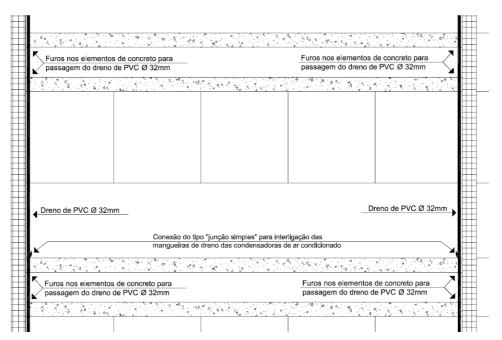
Vista da rede de drenos em pavimento tipo a ser instalada em cada vão
